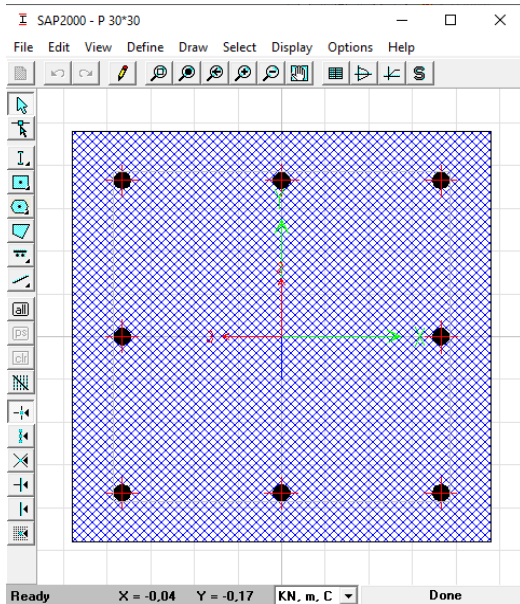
Dessin de ferrailage des poteaux (30×30)
